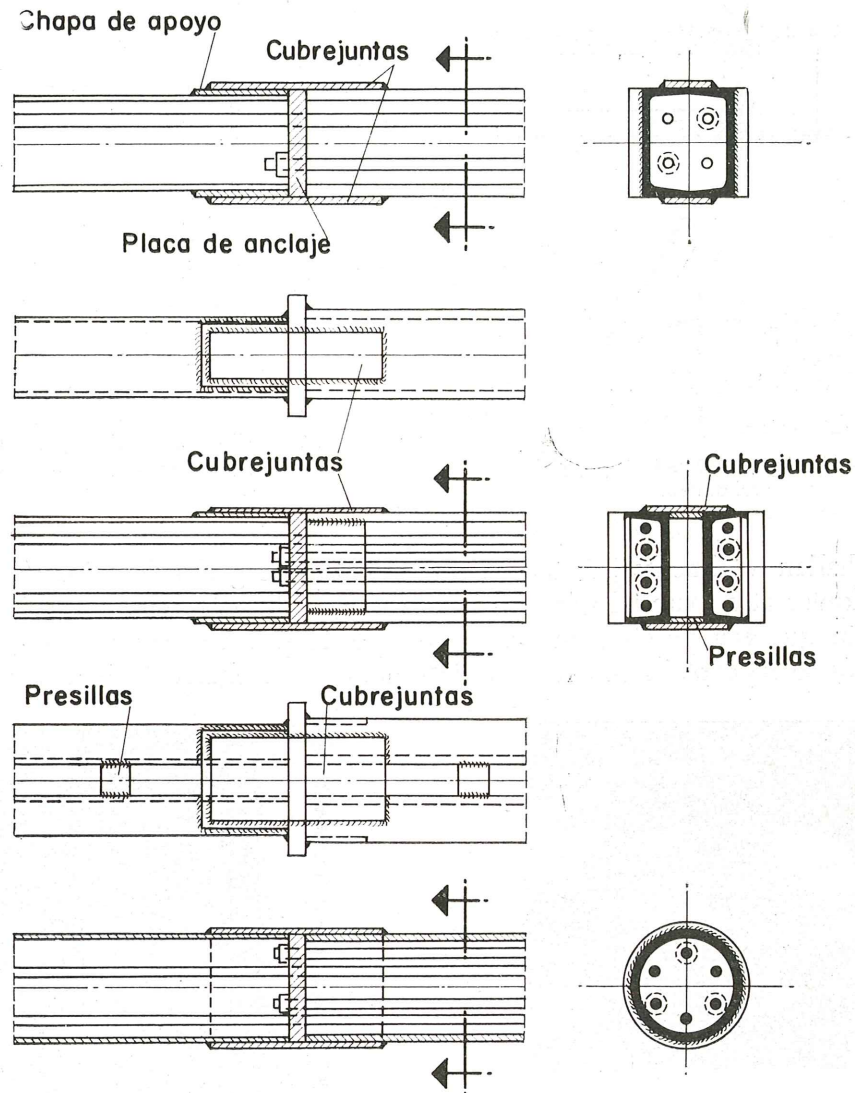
Disposiciones de anclajes intermedios, con barras pasantes.
